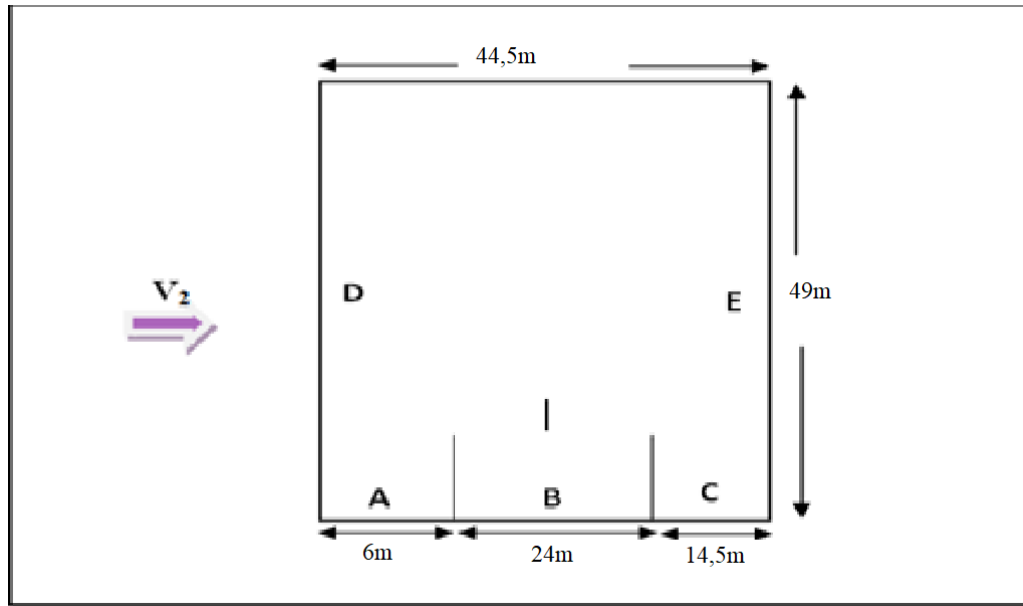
Vue en plan des zones de pression sur les parois verticales sens V_2 .
